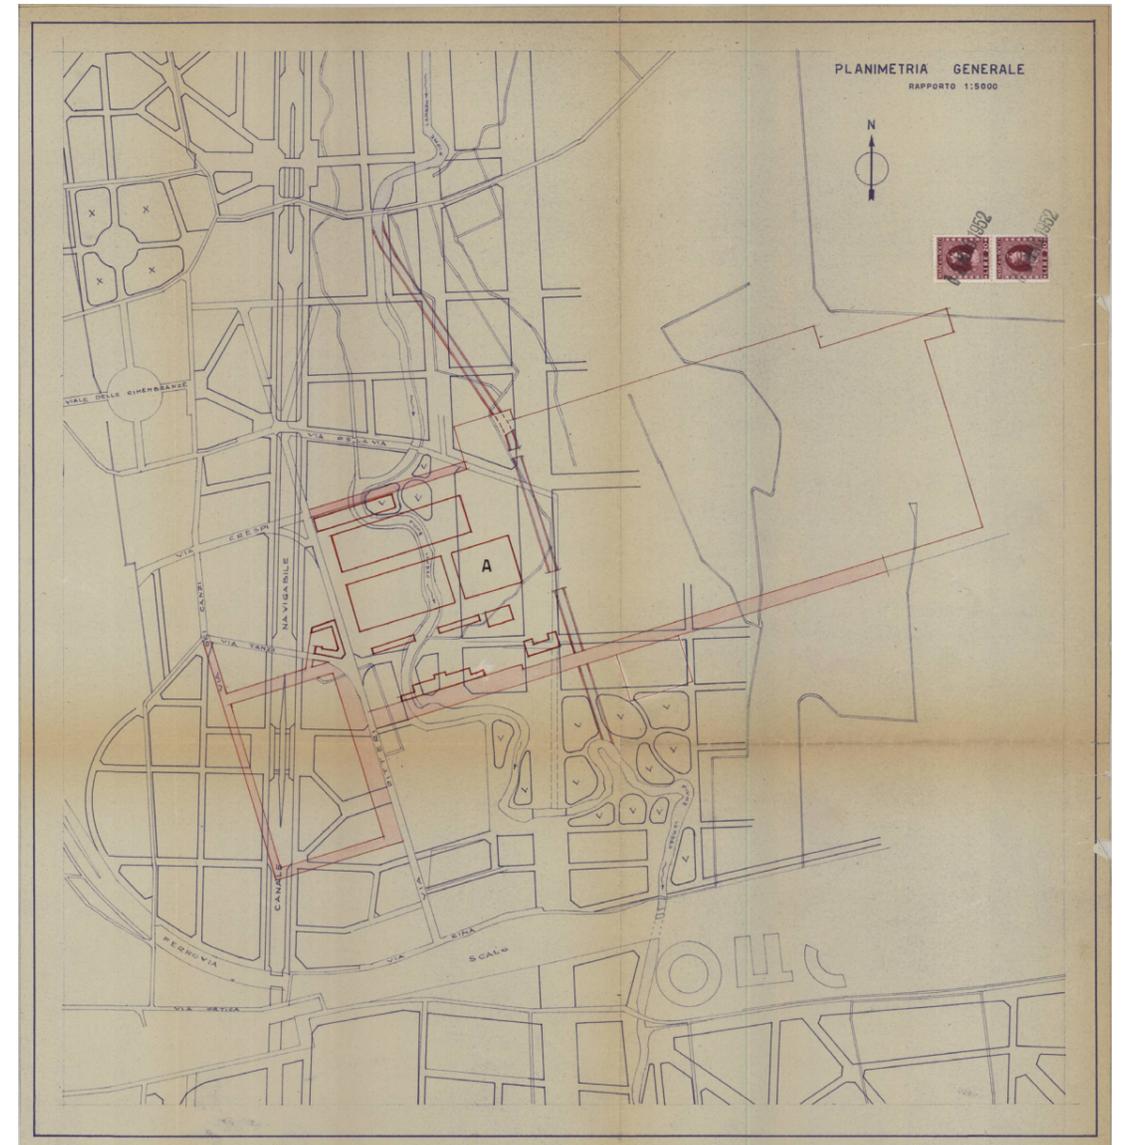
| “Planimetria Generale - Rapporto 1:5000”, 5 marzo 1952 | fonte: Cittadella degli Archivi
